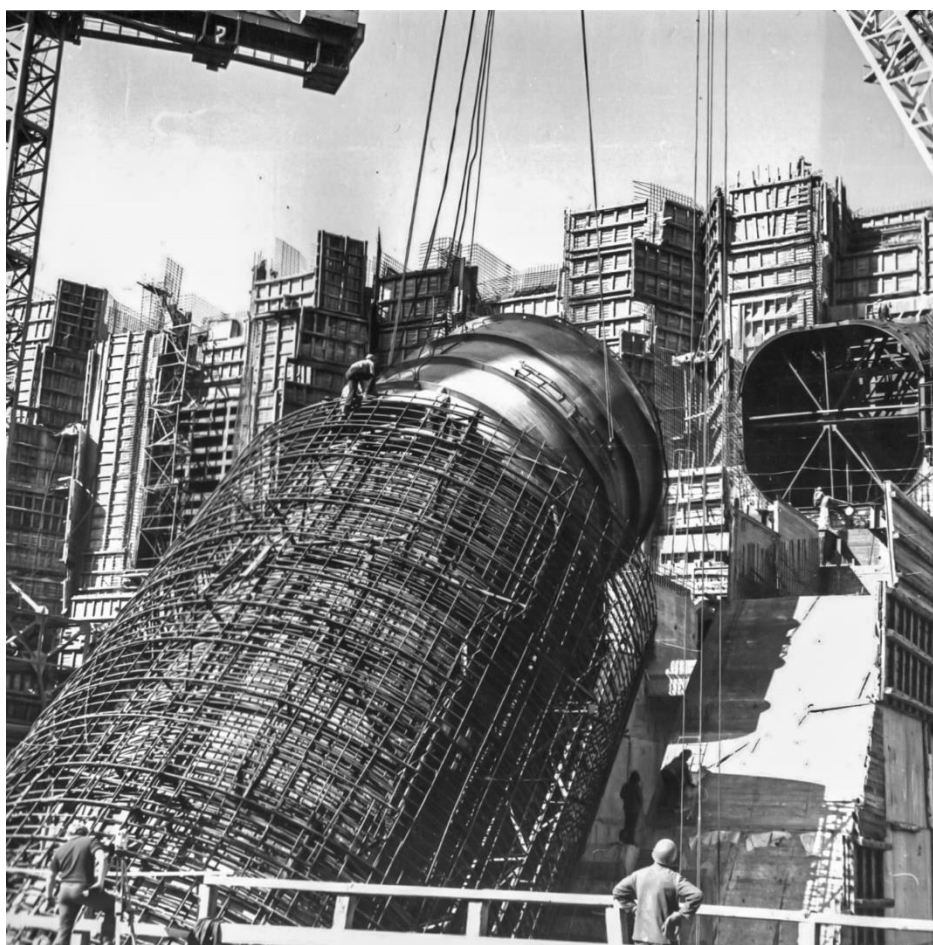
Монтаж звена турбинного водовода на Зейской ГЭС
